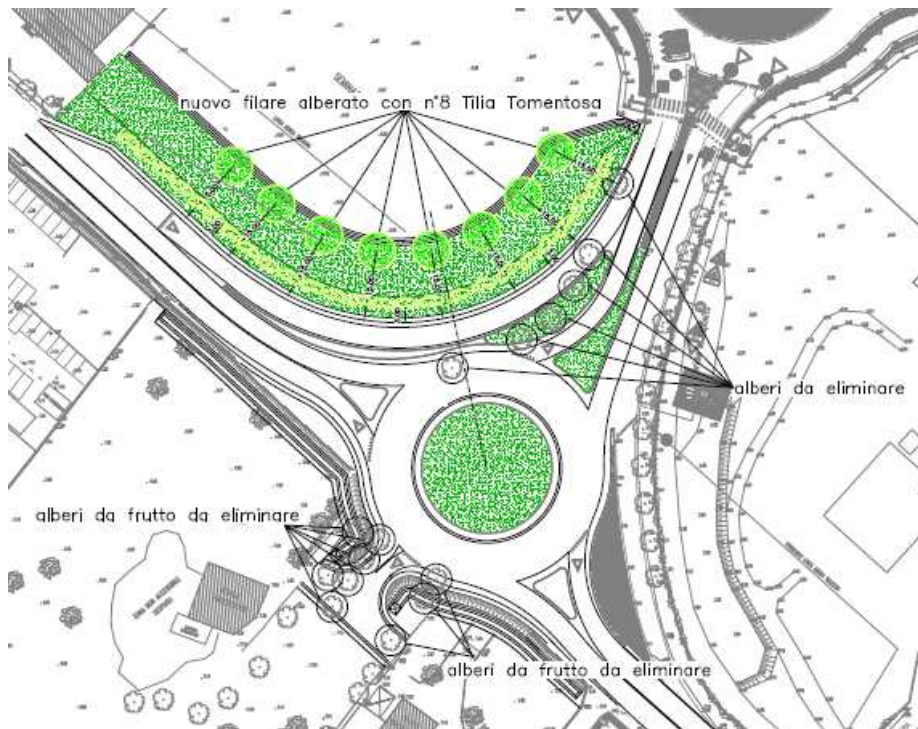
Stralcio tavola 13 Planimetria del verde
